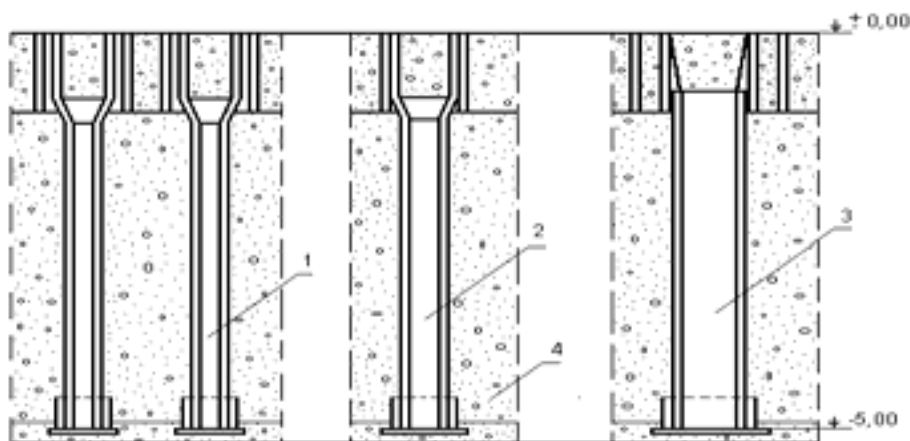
Хранилище для высокоактивных отходов (1 – хранилище для упаковок диаметром 200 мм; 2 – хранилище для упаковок диаметром 300 мм; 3 – хранилище для упаковок диаметром 400 мм, 4 – бетонный монолит).
